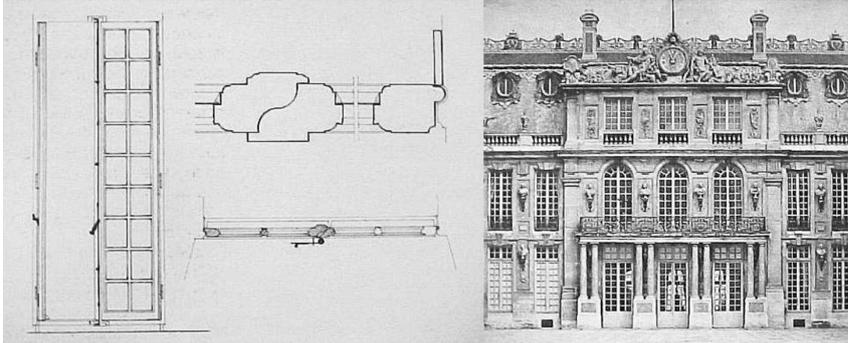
Detalle de carpintería en Palacio de Versalles.
